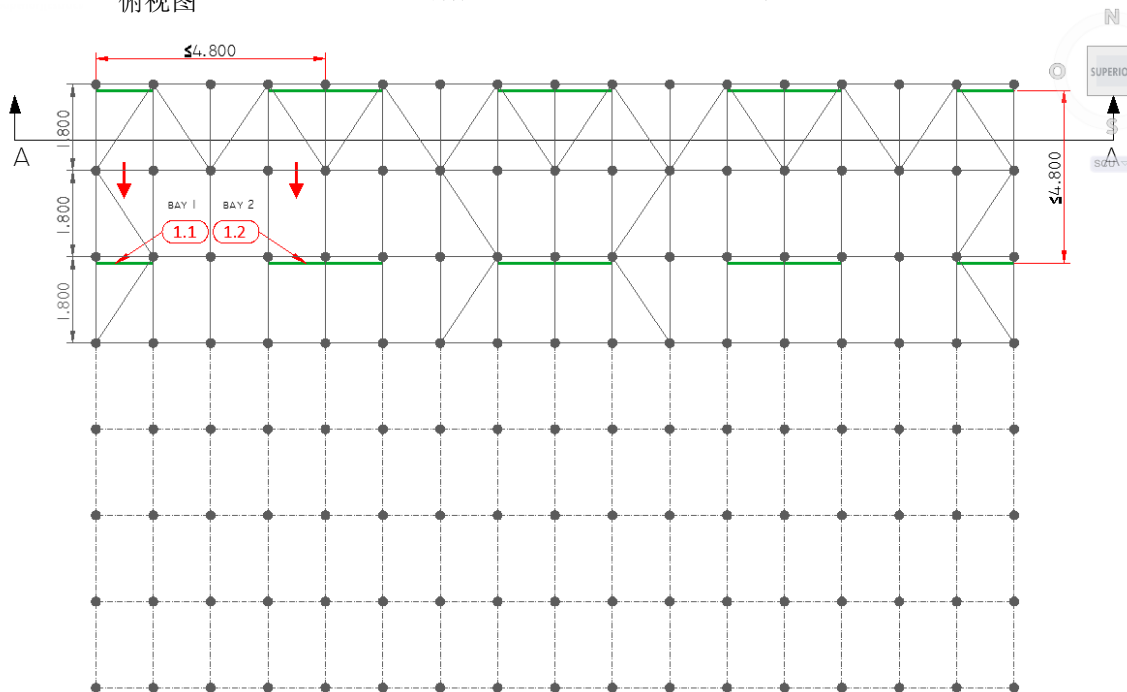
竖向斜杆（纵向）支架纵间距1.2m 平面图
